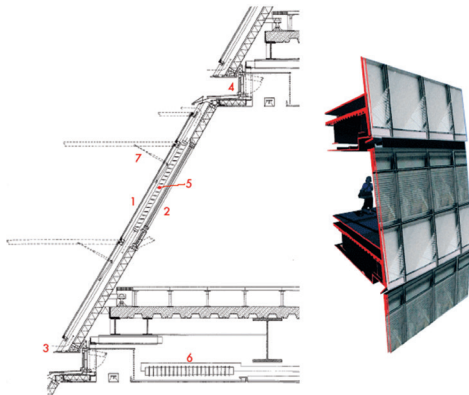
Схема конструкції північного фасаду будівлі мерії Лондону:
